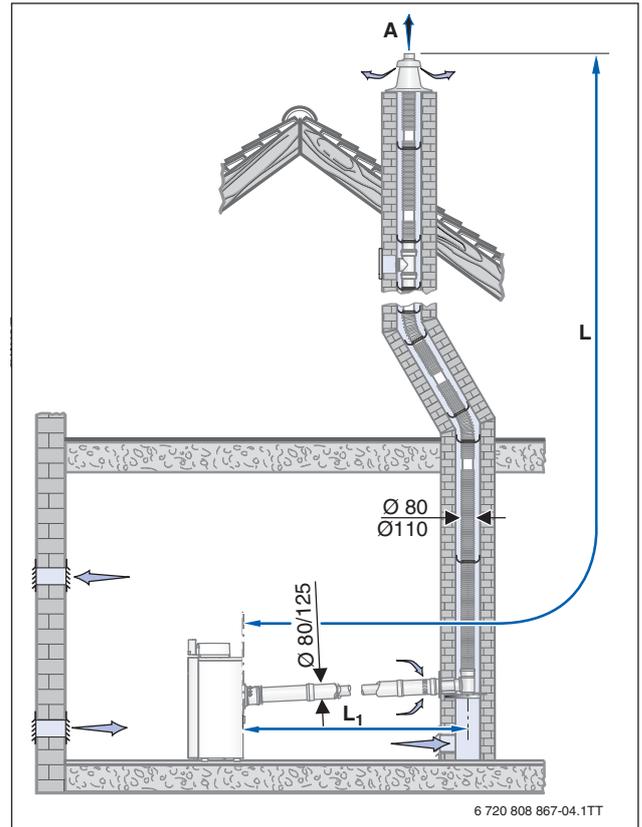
Montagevariante mit dem Bausatz GA-X + GA-K + ÜB-Flex
